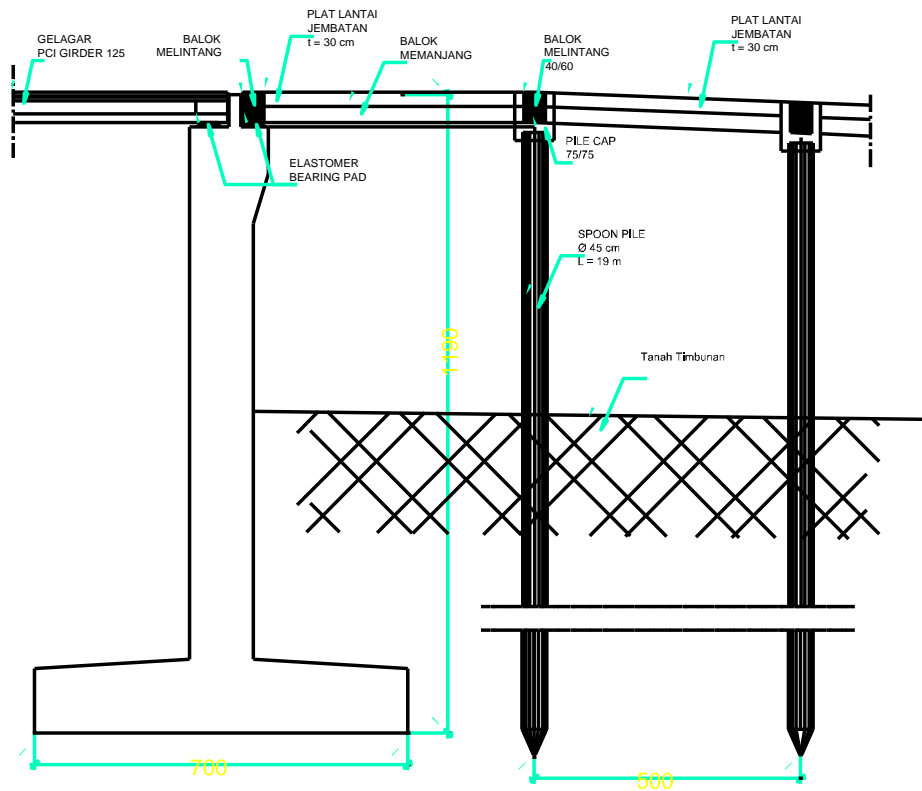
Sketsa Memanjang Sepanjang Oprit
